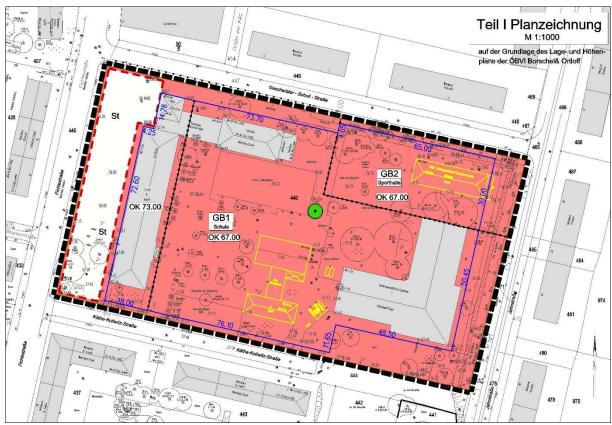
Planzeichnung des rechtskräftigen B-Plans v. 24.04.2020 mit räumlichem Geltungsbereich
